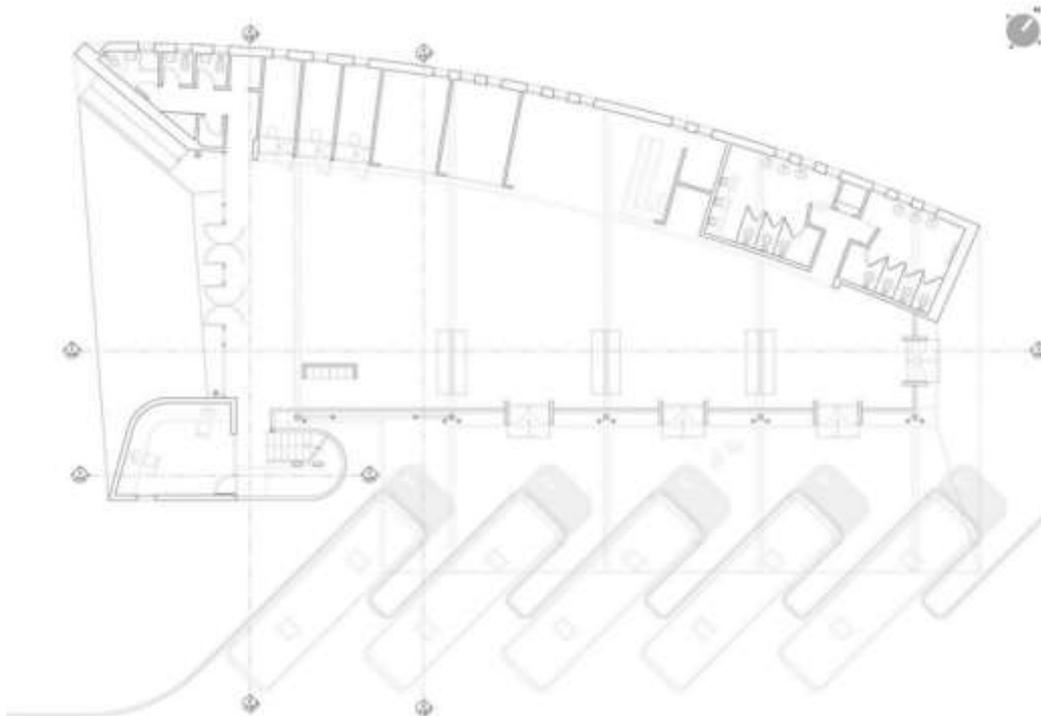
Planta primer nivel del Terminal de buses los Lagos
